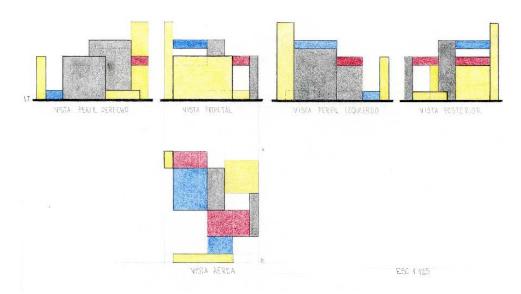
Sistema Monge -Planta y vistas- del conjunto
